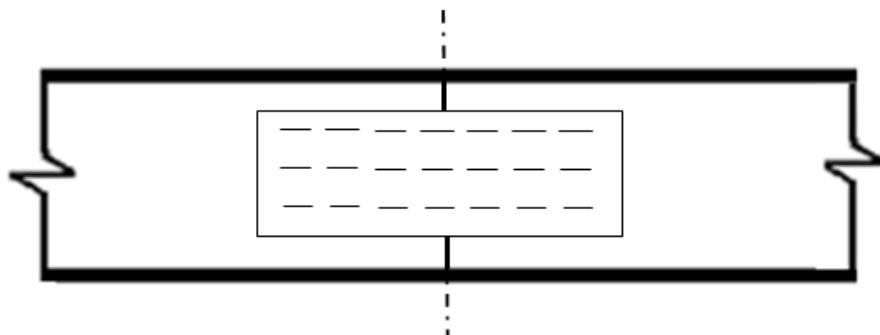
Fixação de peças de madeira utilizando chapa com dentes estampados
